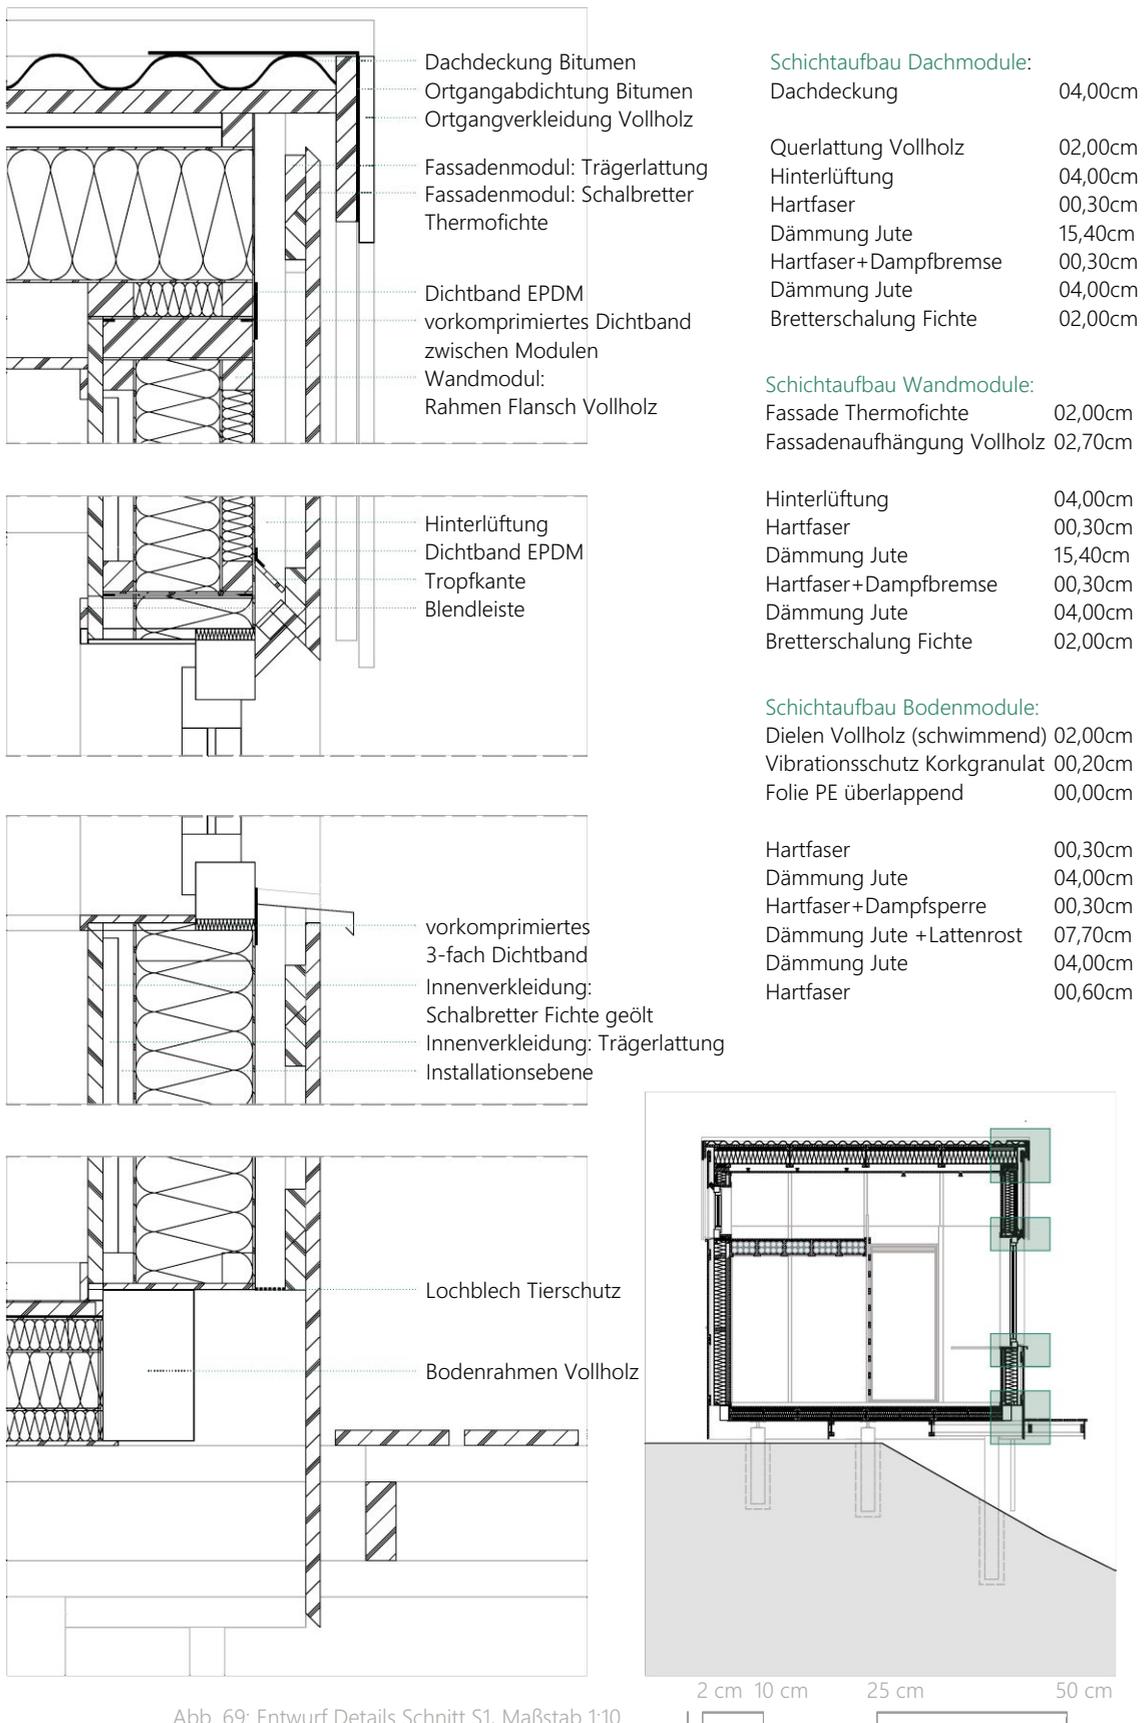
Entwurf Details Schnitt S1, Maßstab 1:10
